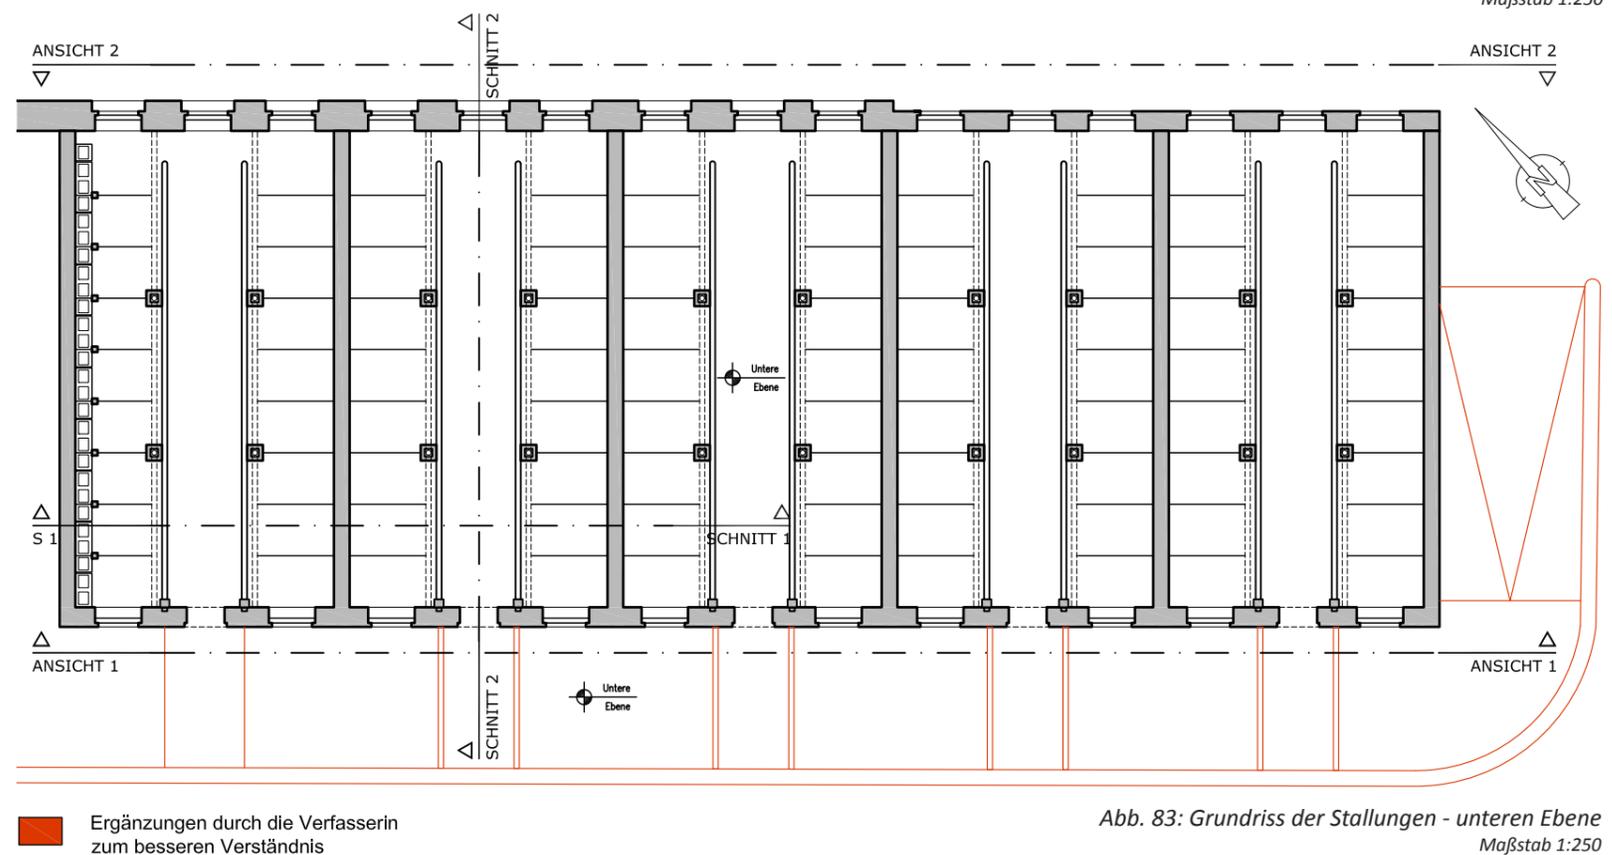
Grundriss der Stallungen - unteren Ebene
